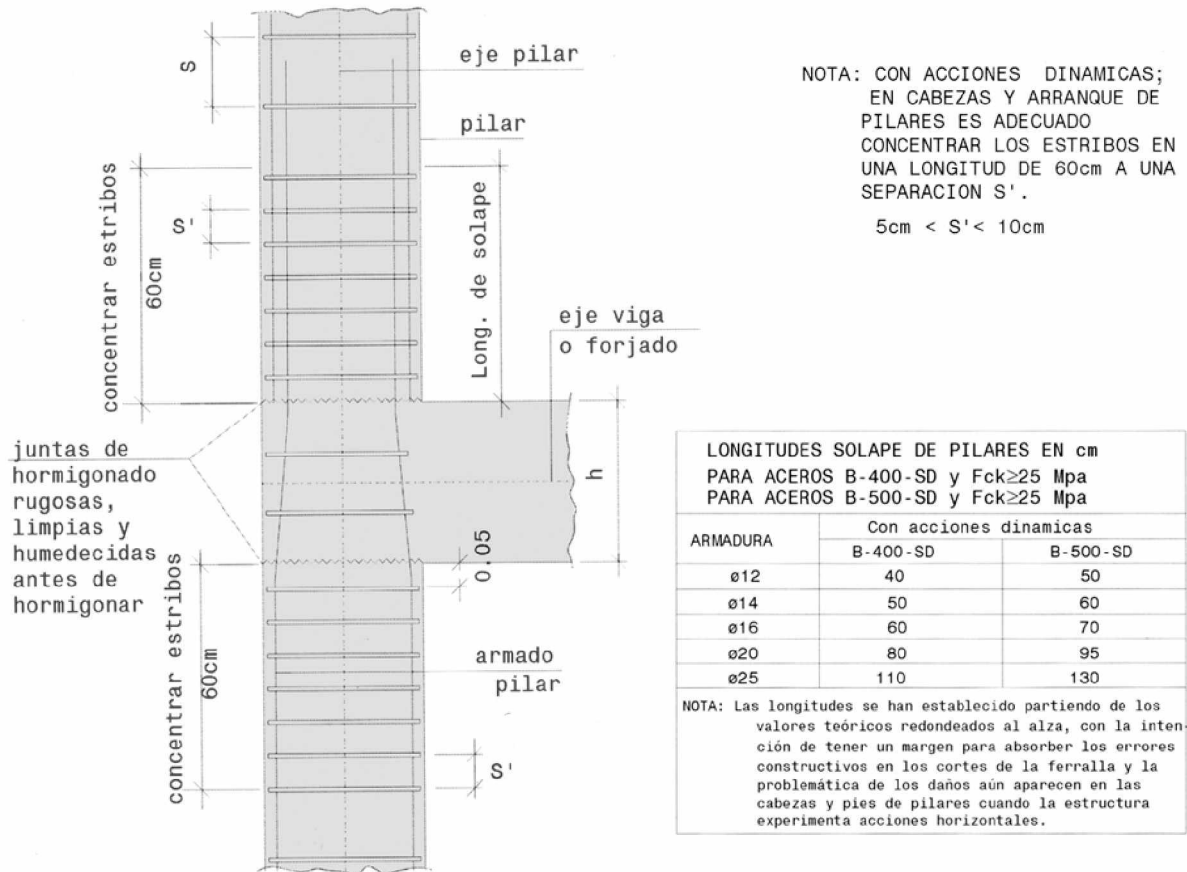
Esquema de armado de pilar en unión con viga y forjado. Concentración de estribos en cabeza y pie de pilar en presencia de acciones dinámicas.
